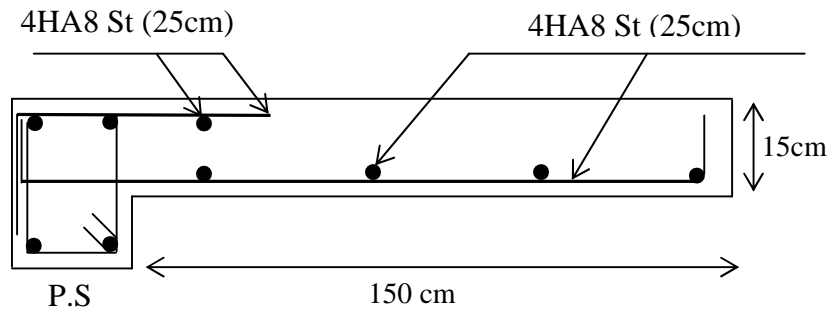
Schéma de ferrailage des dalles pleines internes
